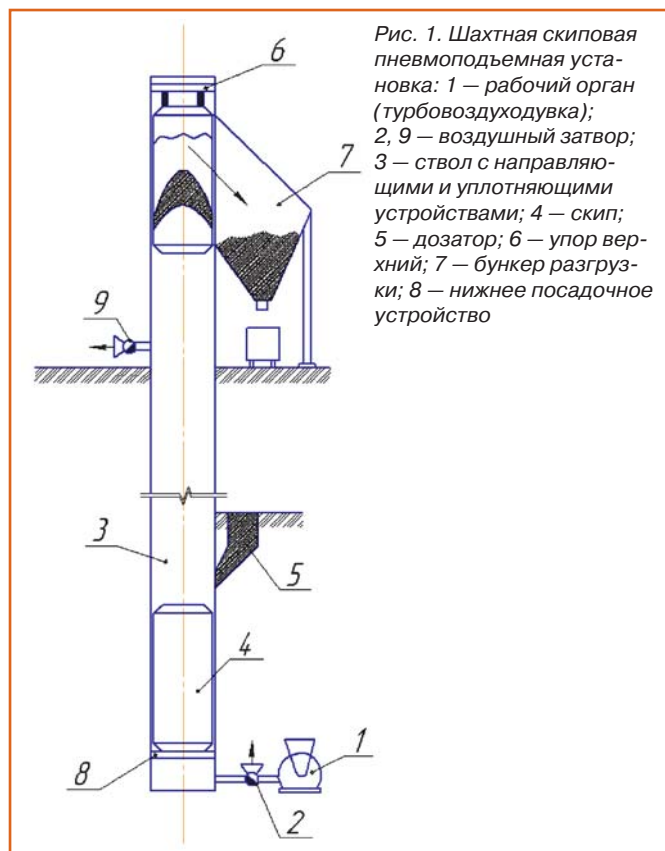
Шахтная скиповая пневмоподъемная установка: 1 — рабочий орган (турбовоздуходувка); 2, 9 — воздушный затвор; 3 — ствол с направляющими и уплотняющими устройствами; 4 — скип; 5 — дозатор; 6 — упор верхний; 7 — бункер разгрузки; 8 — нижнее посадочное устройство
